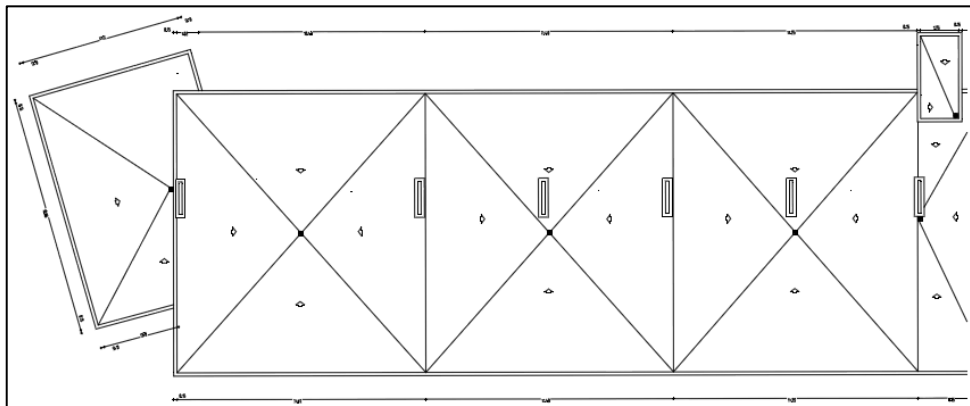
juntas 9 y 10 – Cubierta. Fuente propia
